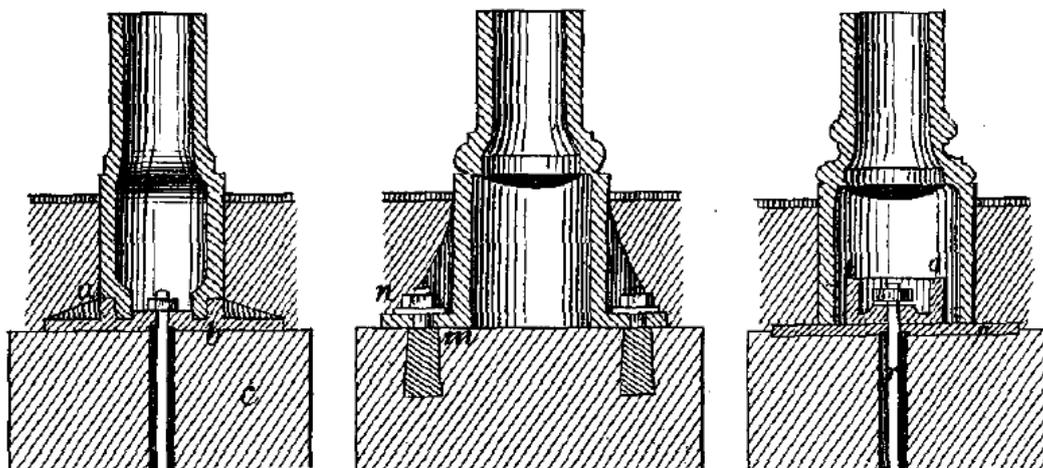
Asiento de columnas en cimentación (Figuras 413, 413' y 415)
